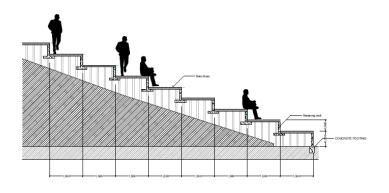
19 Potongan Bangunan C1-C1 (R. Badminton & Voli)
